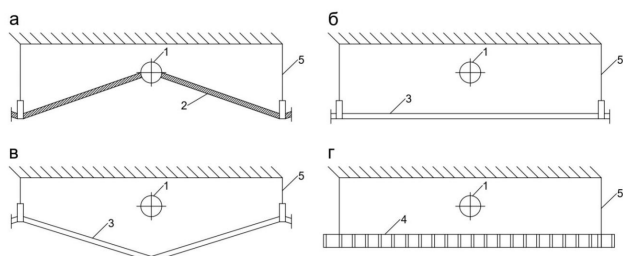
Схемы осветительных подвесных потолков: а - с глубокими отражателями; б - со светопропускающими экранами; в - с объемными светопропускающими экранами; г - с жалюзийной решеткой, 1 - светильник; 2-глухие панели; 3 - прозрачные панели; 4 - перекрестные ребра; 5 - подвески.
